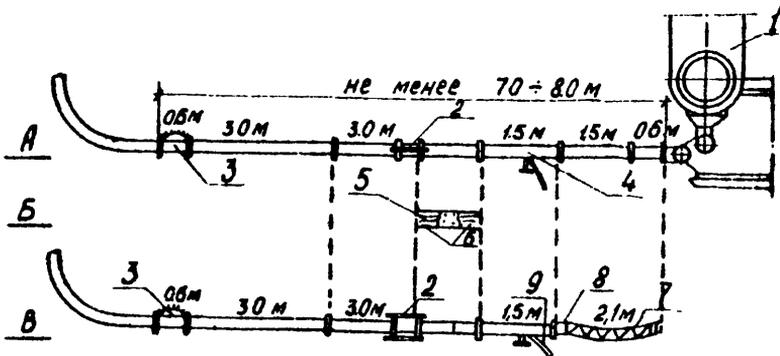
Схема раскладки бетоновода у бетононасоса.
